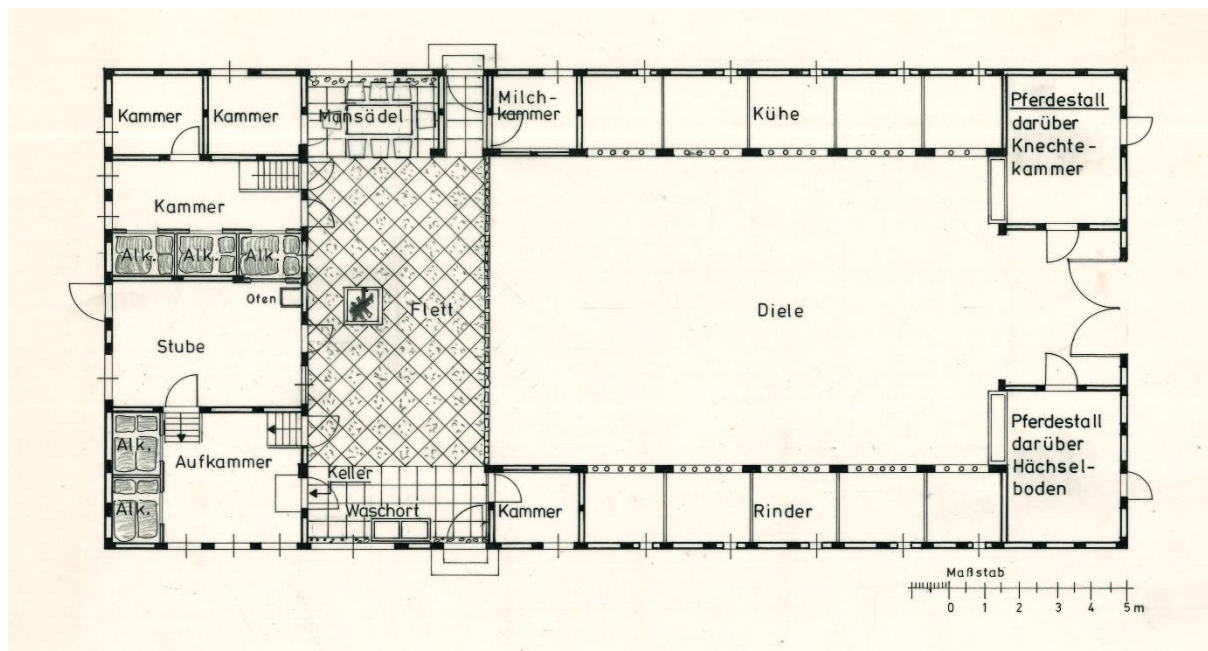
Niederdeutsches Hallenhaus, Hof Haake, Museumsdorf Cloppenburg. Grundriss von Günther Geuter, 1984 (Z.Nr. 328.2).
